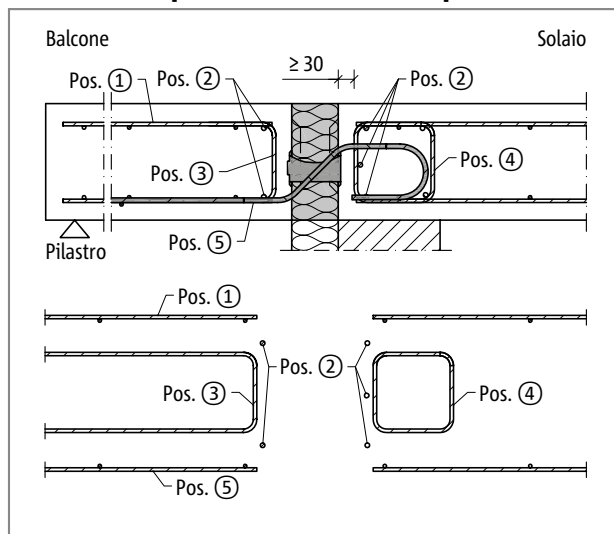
Schöck Isokorb® tipo Q10 - Q50: armatura in opera
